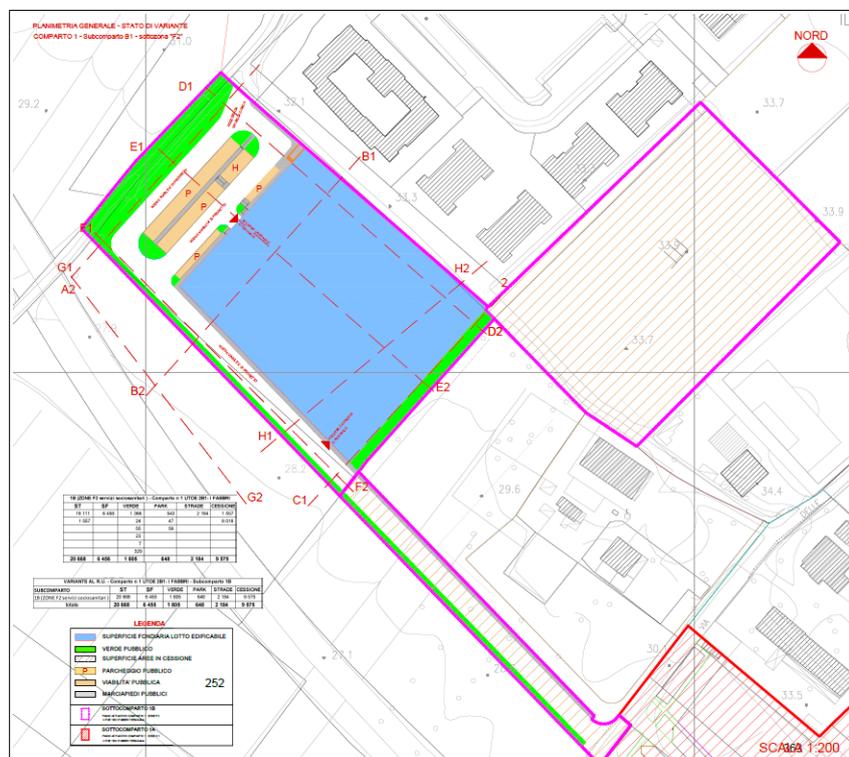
Planimetria generale del sub comparto 1B – I Fabri
